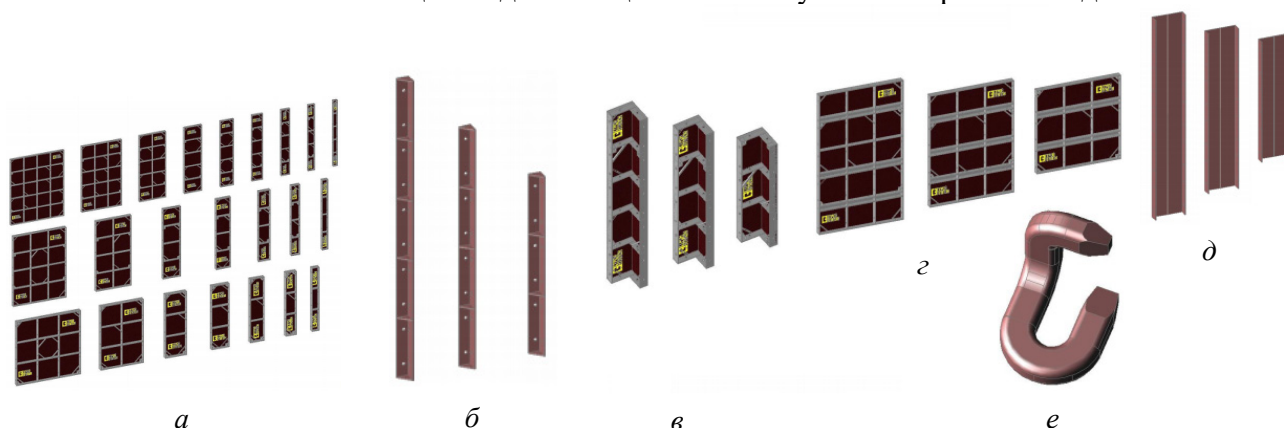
Элементы мелкощитовой опалубки: *а* – щит линейный; *б* – угловой элемент; *в* – щит угловой внутренний; *г* – щит универсальный; *д* – щит шарнирный; *е* – замок ударный
